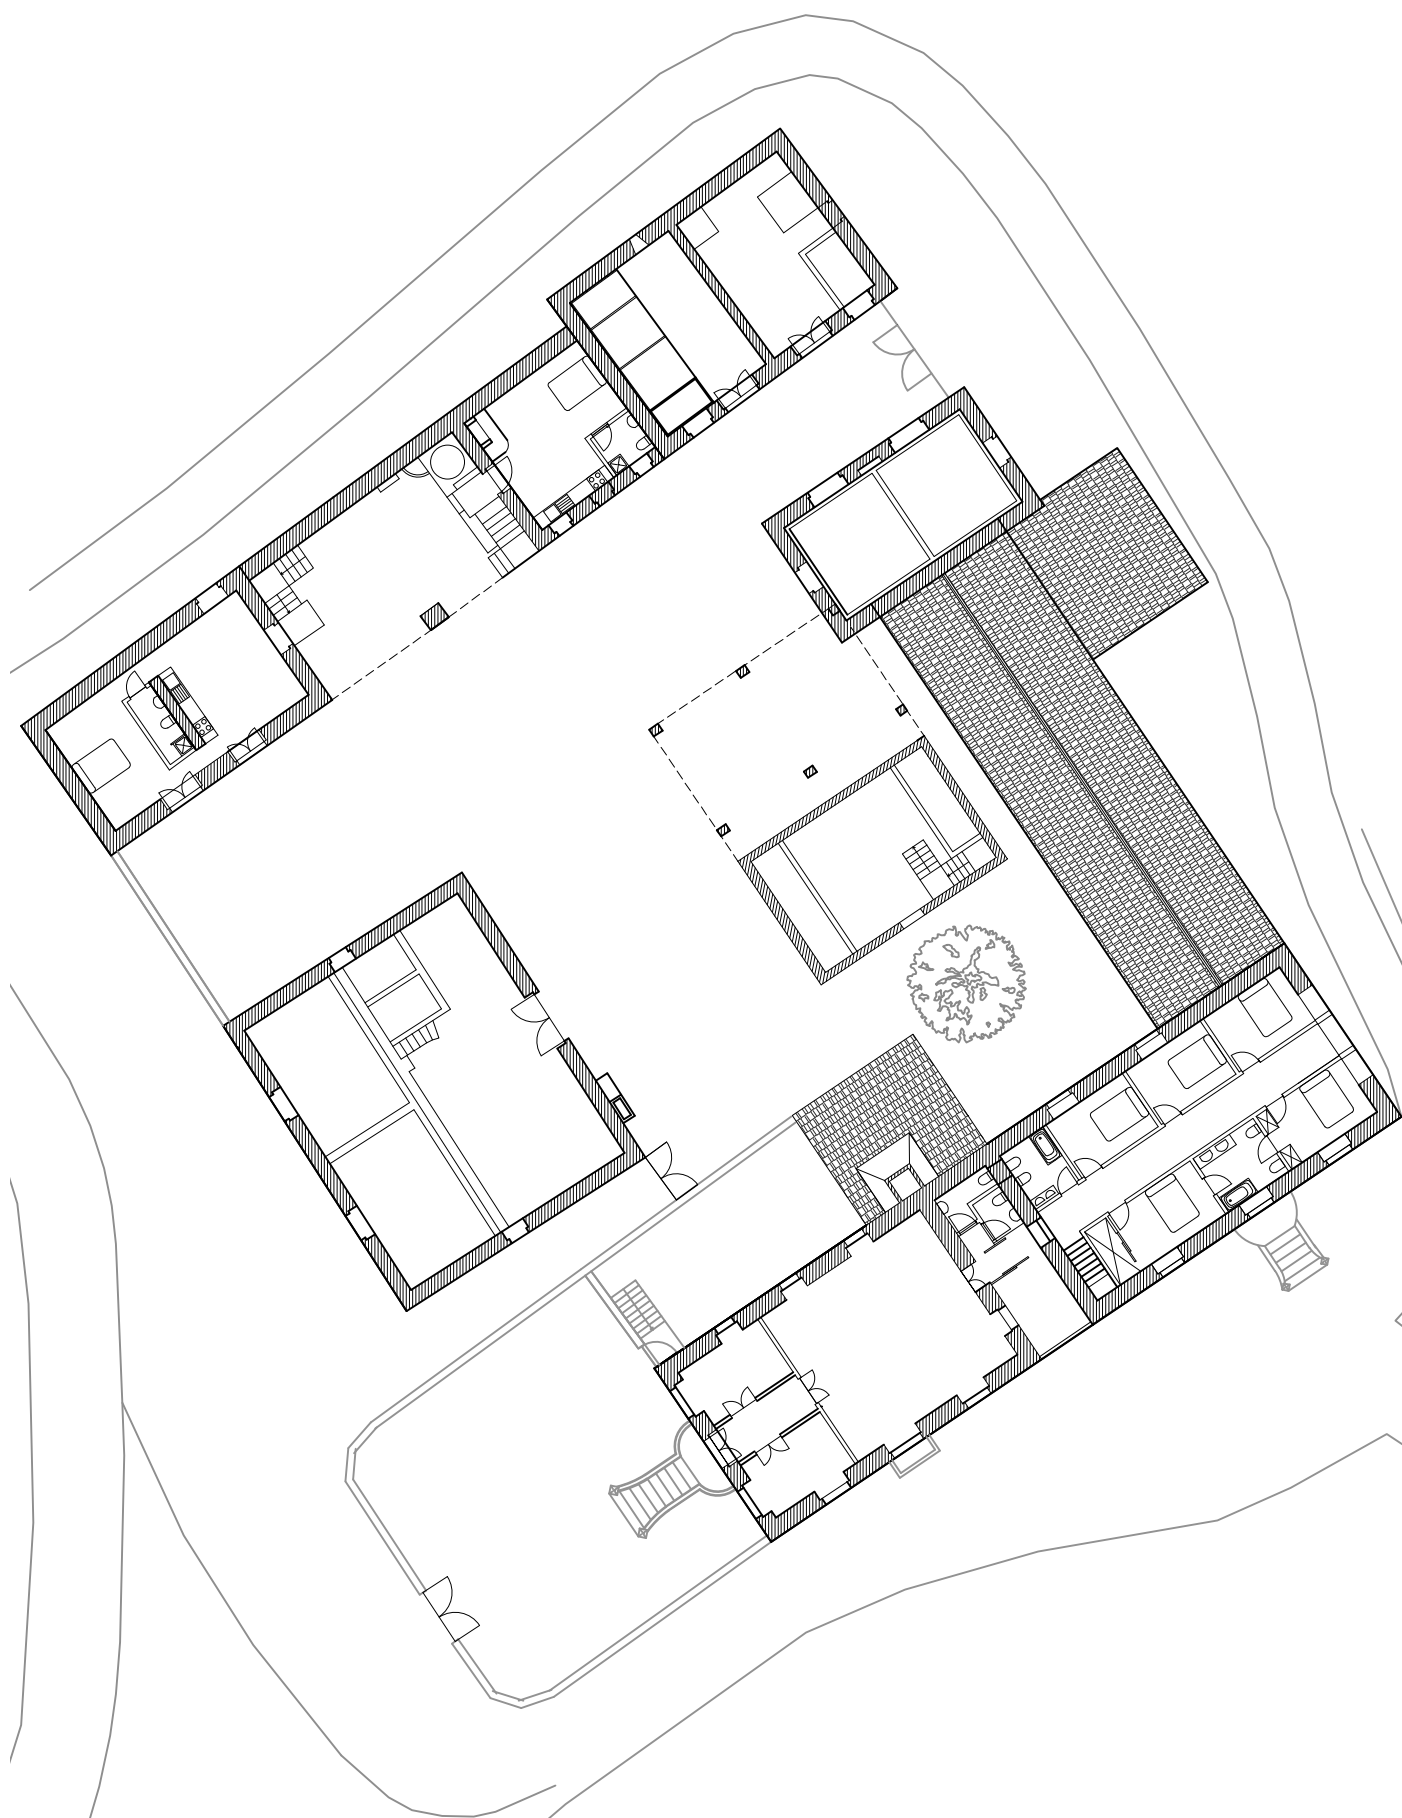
Planta do Piso 1 do Conjunto Arquitetônico
